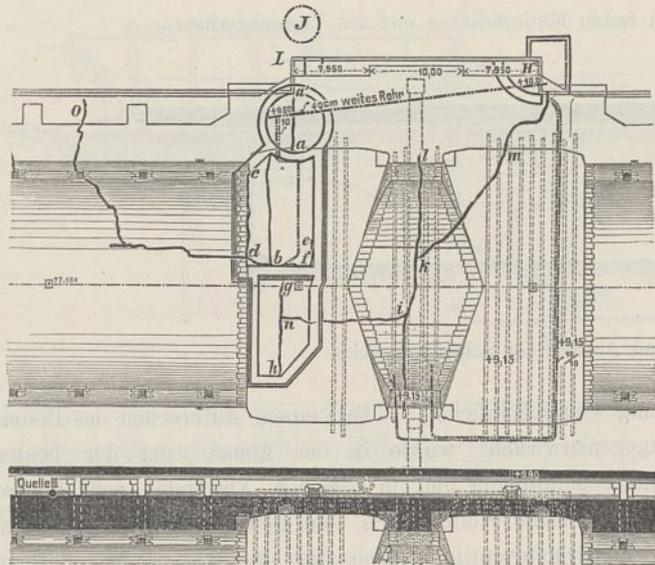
Grundriß des Sperrthorhauptes mit Angabe der durch den Quellaufbruch herbeigeführten Risse im Beton.
